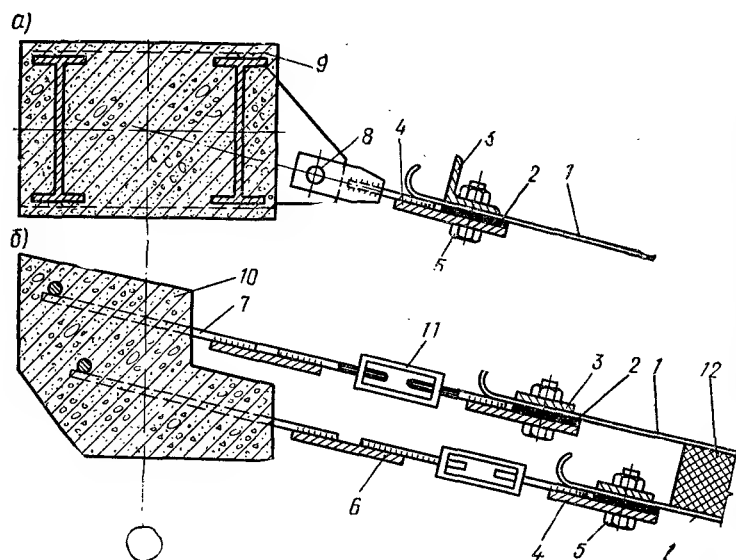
Узлы крепления лент к опорному железобетонному контуру
